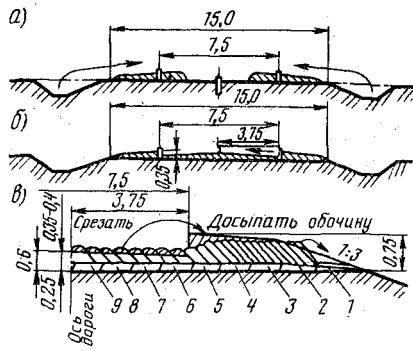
Схема устройства корыта с присыпанными обочинами:
